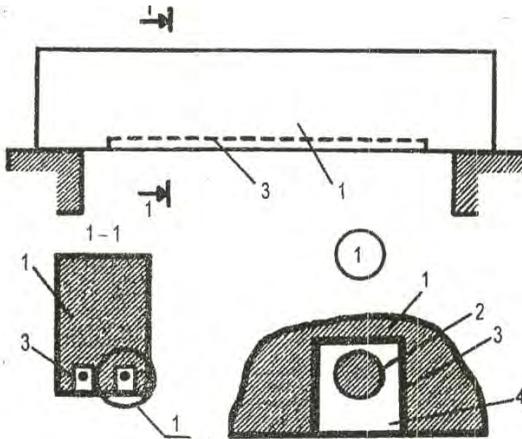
Усиление балки с помощью установки дополнительной арматуры на полимеррастворе:
